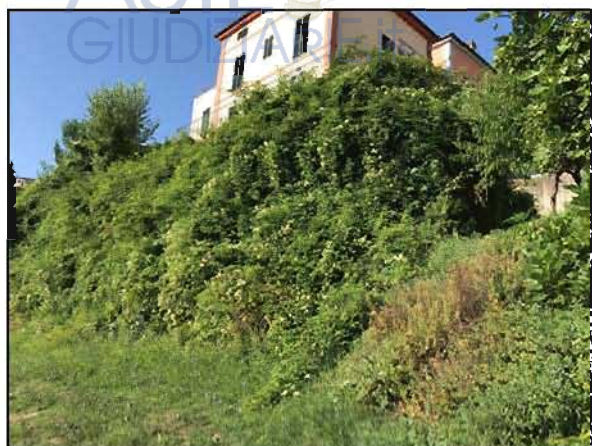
del 2020 il rilevato in terra armata ed il muro in c.a. soprastante ormai completamente ricoperti dalla vegetazione così rigogliosa per la presenza abbondante di umidità e per la natura argillosa del terreno di riempimento del rilevato.
